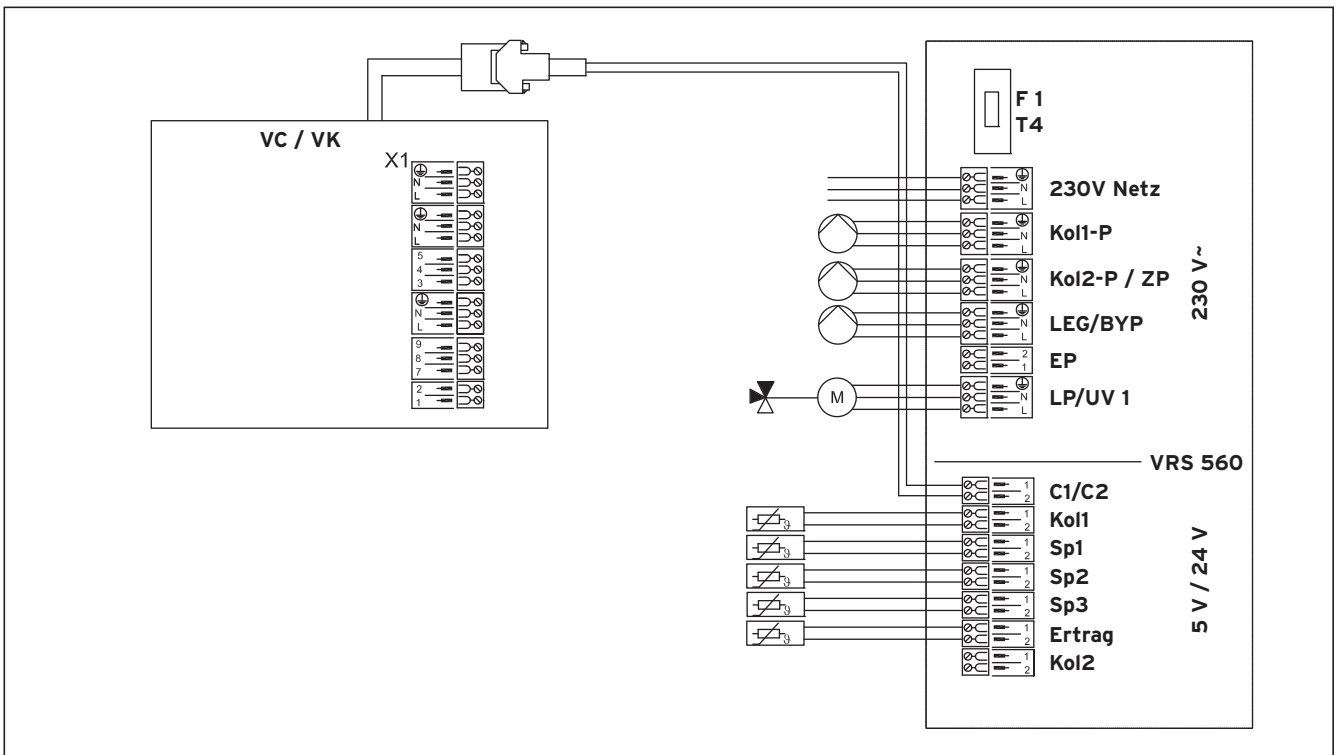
Plan de raccordement pour schéma hydraulique 1 :
